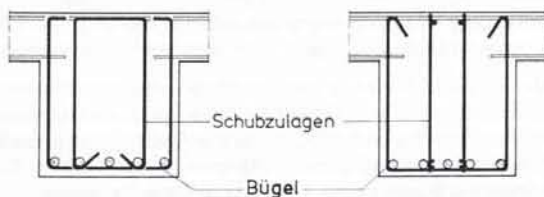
Beispiele für eine Schubbewehrung aus Bügeln und Schubzulagen in Plattenbalken
